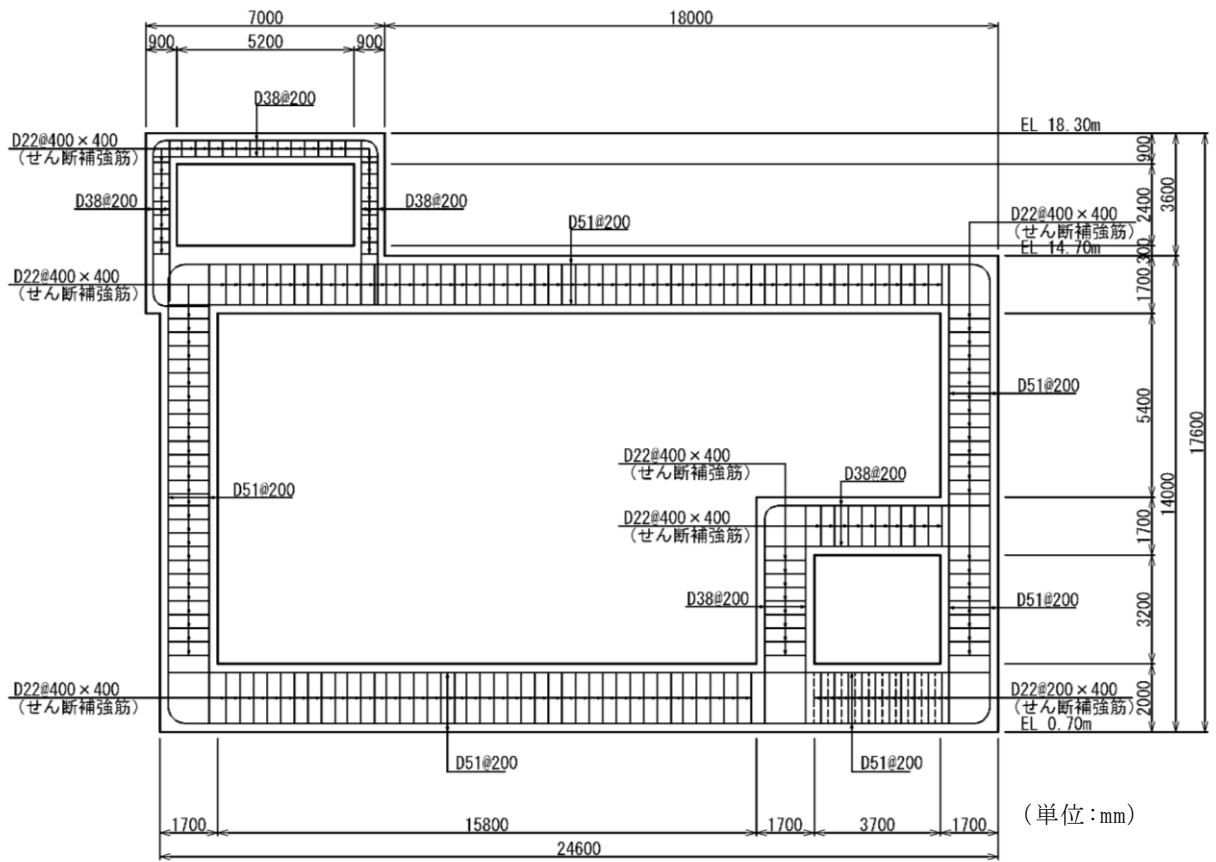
第 1 ベントフィルタ格納槽概略配筋図 (C-C 断面)
